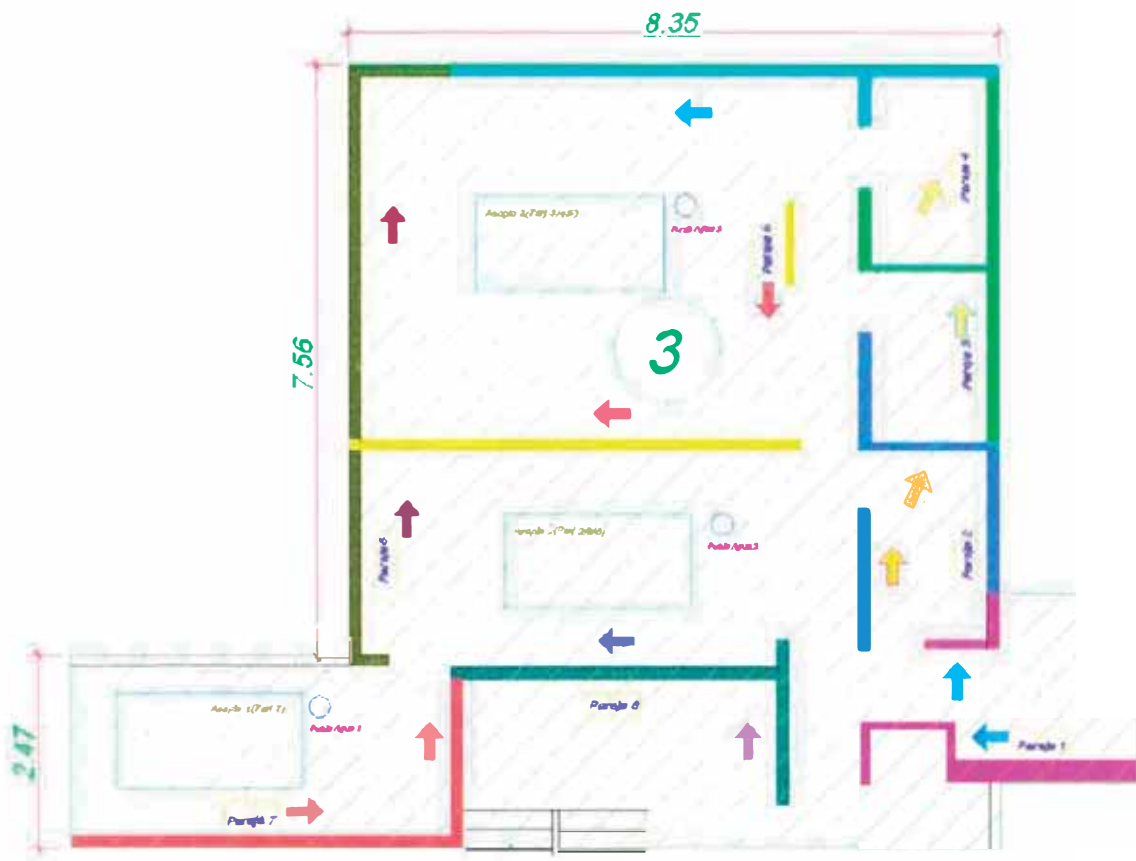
Diagrama de Planta Encofrado de Muros (Fuente: Propia)
